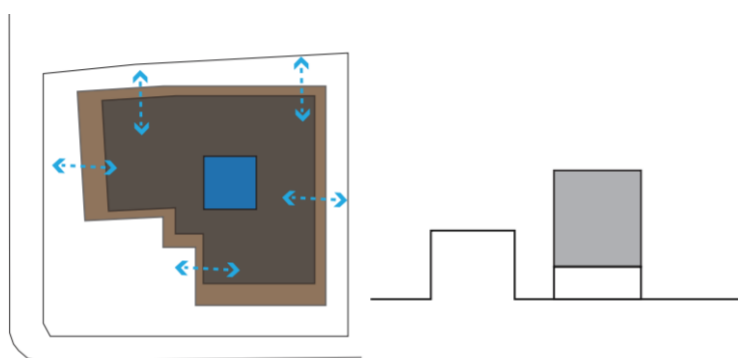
Ocupación mínima del área en planta baja. Elaboración propia 2019.
